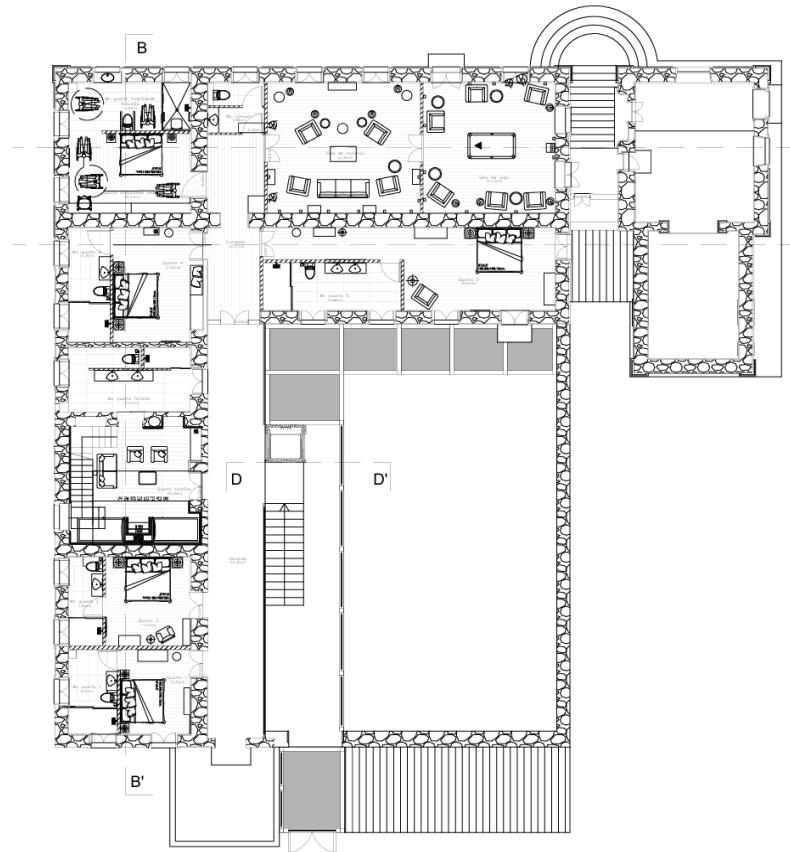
Planta de apresentação do piso 1, Fonte: Autor
